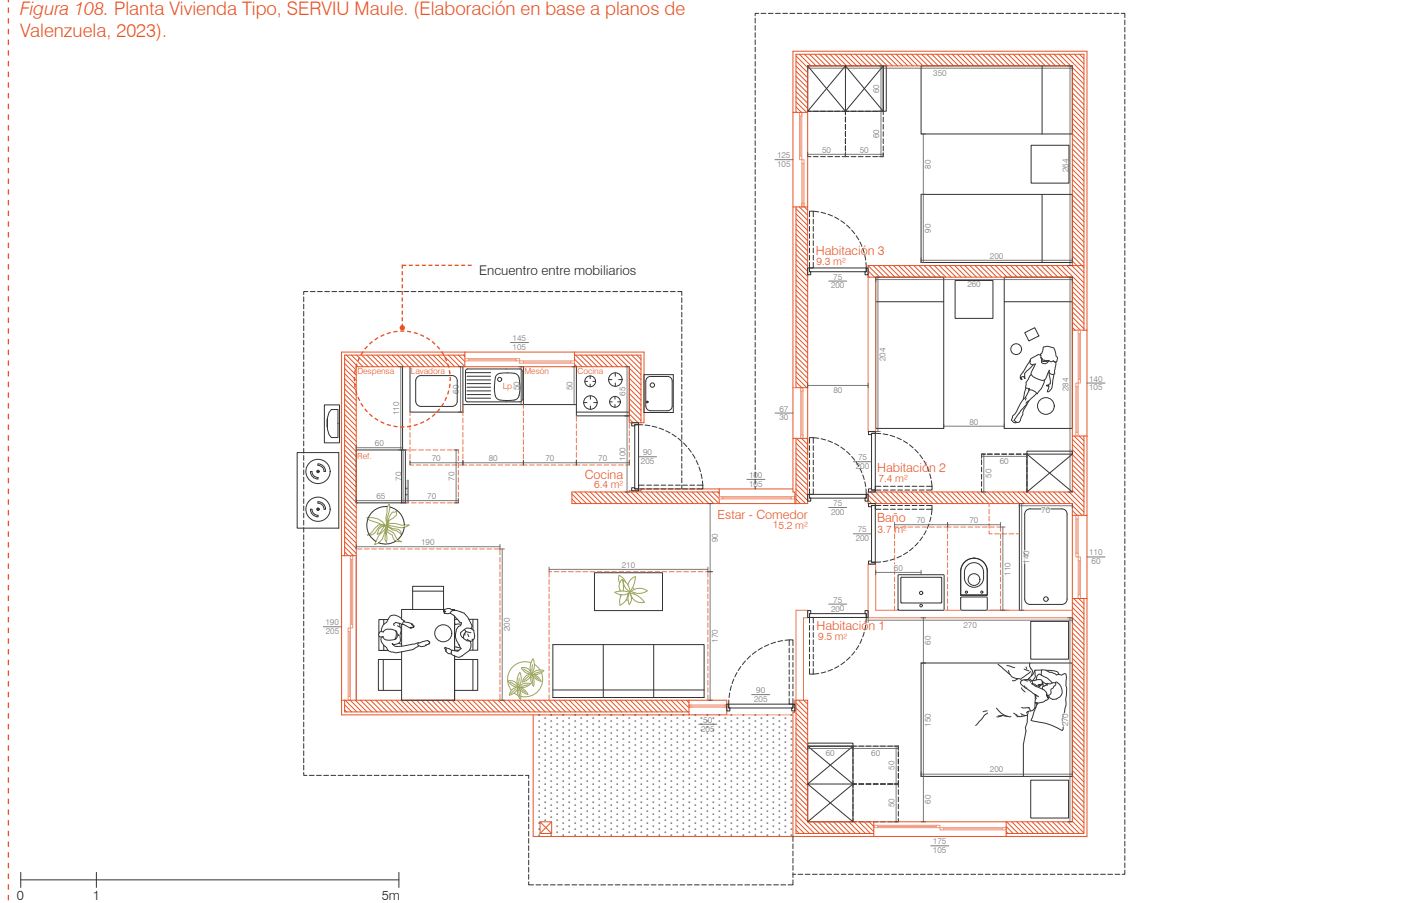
Planta Vivienda Tipo, SERVIU Maule. (Elaboración en base a planos de Valenzuela, 2023).
